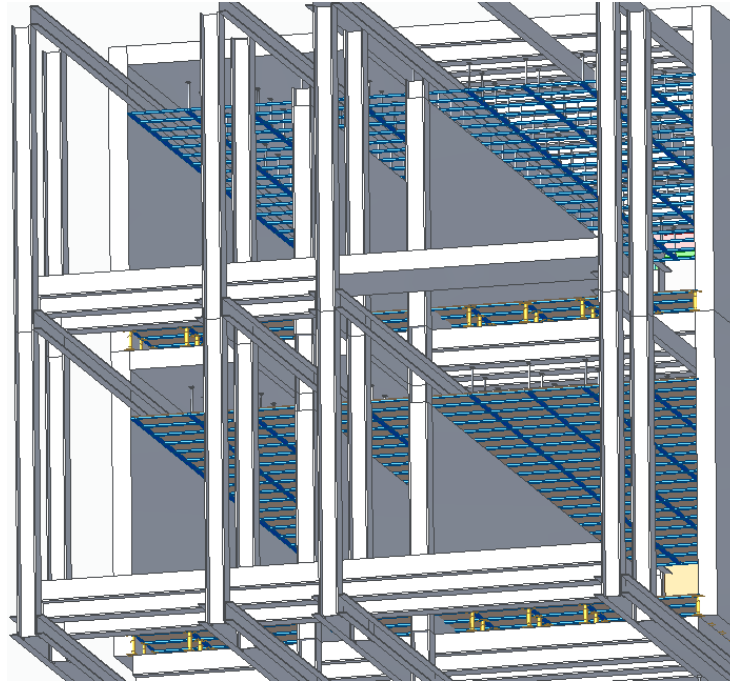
Colocación de los perfiles Secundarios del Techo
